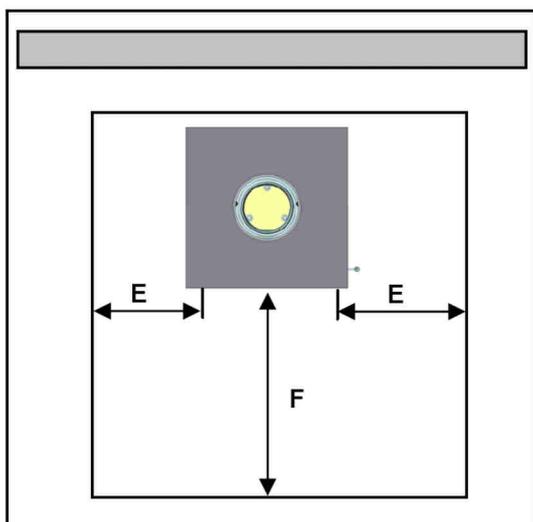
Funkenschutzvorlage „samurai“ / „samurai oki“
